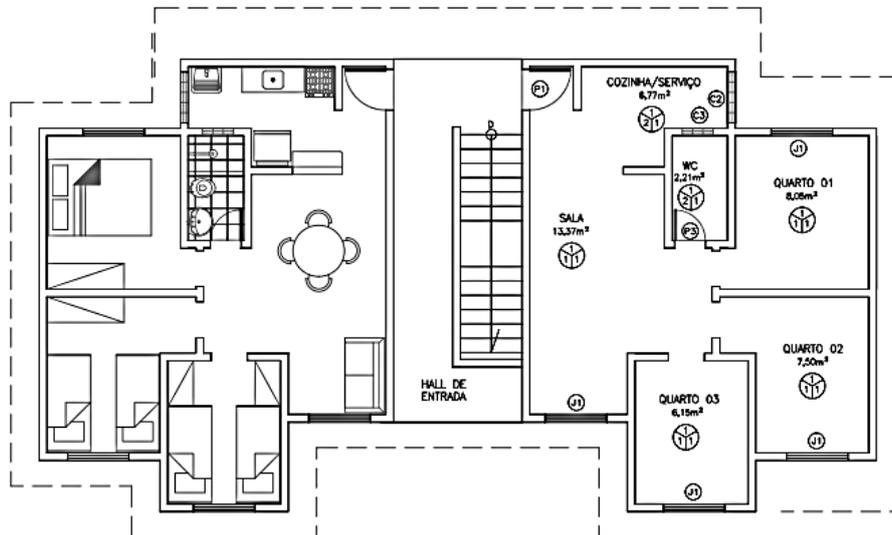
Planta Baixa do bloco tipo A. 3º pavimento. T2.
